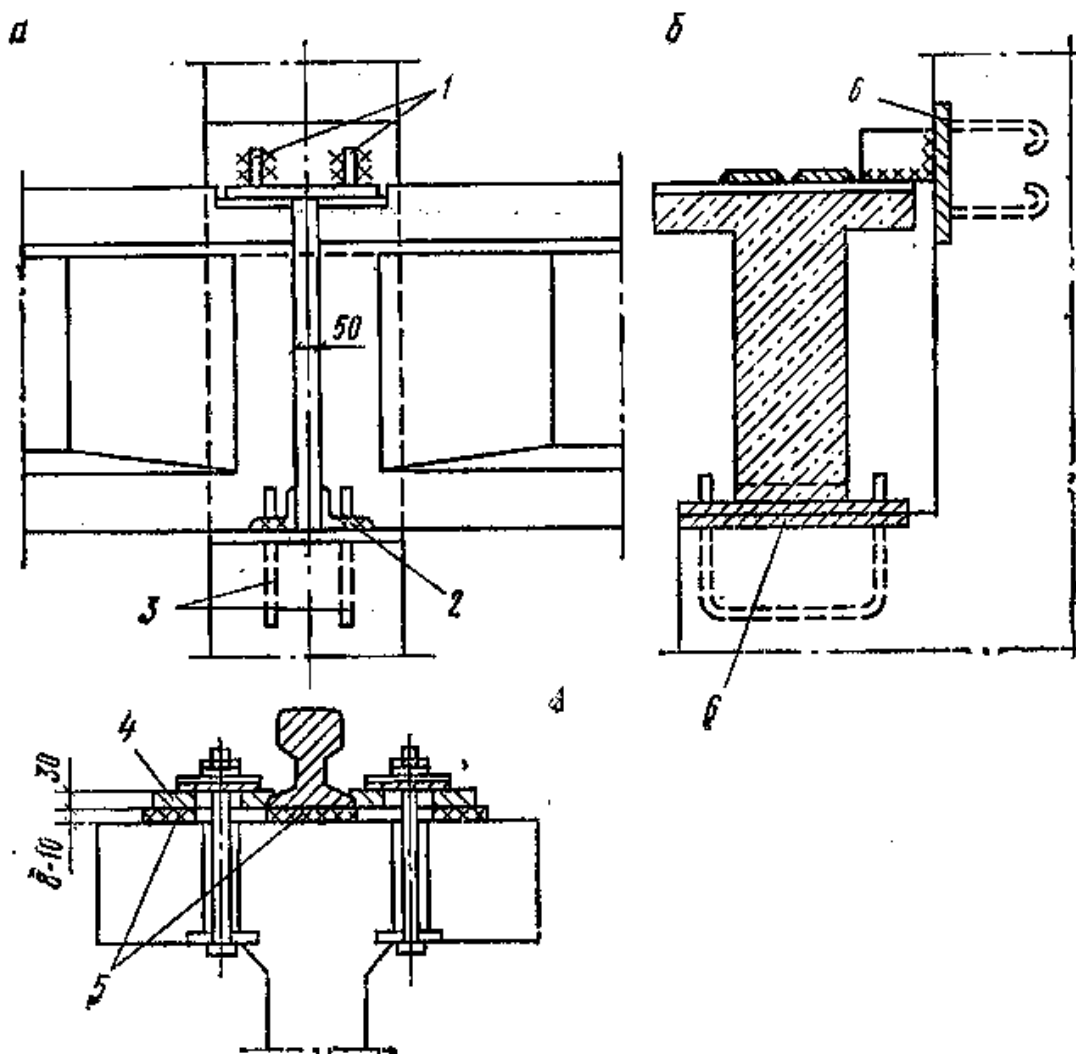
Детали креплений: а - подкрановой балки к колонне; б - рельса к подкрановой балке; 1 - ребровые планки 100×12; 2 - закладная деталь подкрановой балки; 3 - анкеры, выпущенные из колонны; 4 - лапка-прижим; 5 - упругие прокладки; 6 - закладные детали колонны $\delta = 8$ мм.
